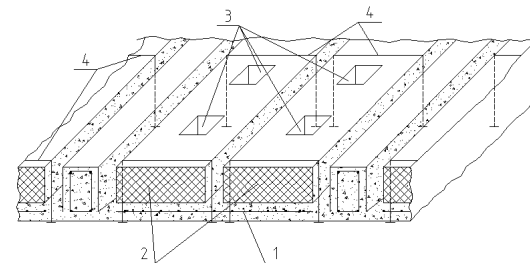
Сборно – монолитное железобетонное перекрытие: 1 – арматурная сетка; 2 – теплоизоляционные вкладыши; 3 – сквозные отверстия во вкладышах; 4 – металлические скобы (крепятся к опалубке)
